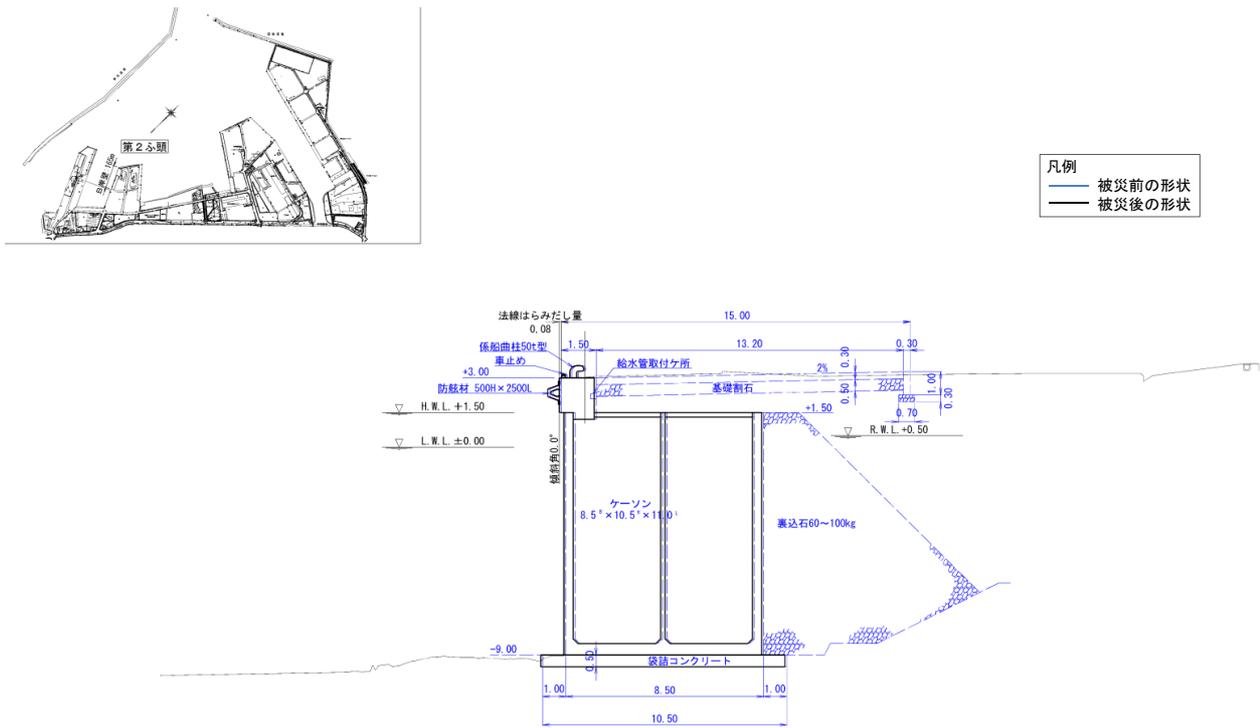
No.5 日立港区_第2埠頭地区 2-B岸壁 (-9m) の断面図 (被災前・後)
